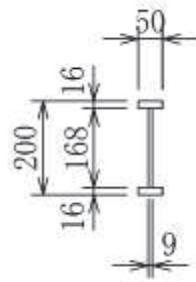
補助縦桁の断面形状 (単位 : mm)
